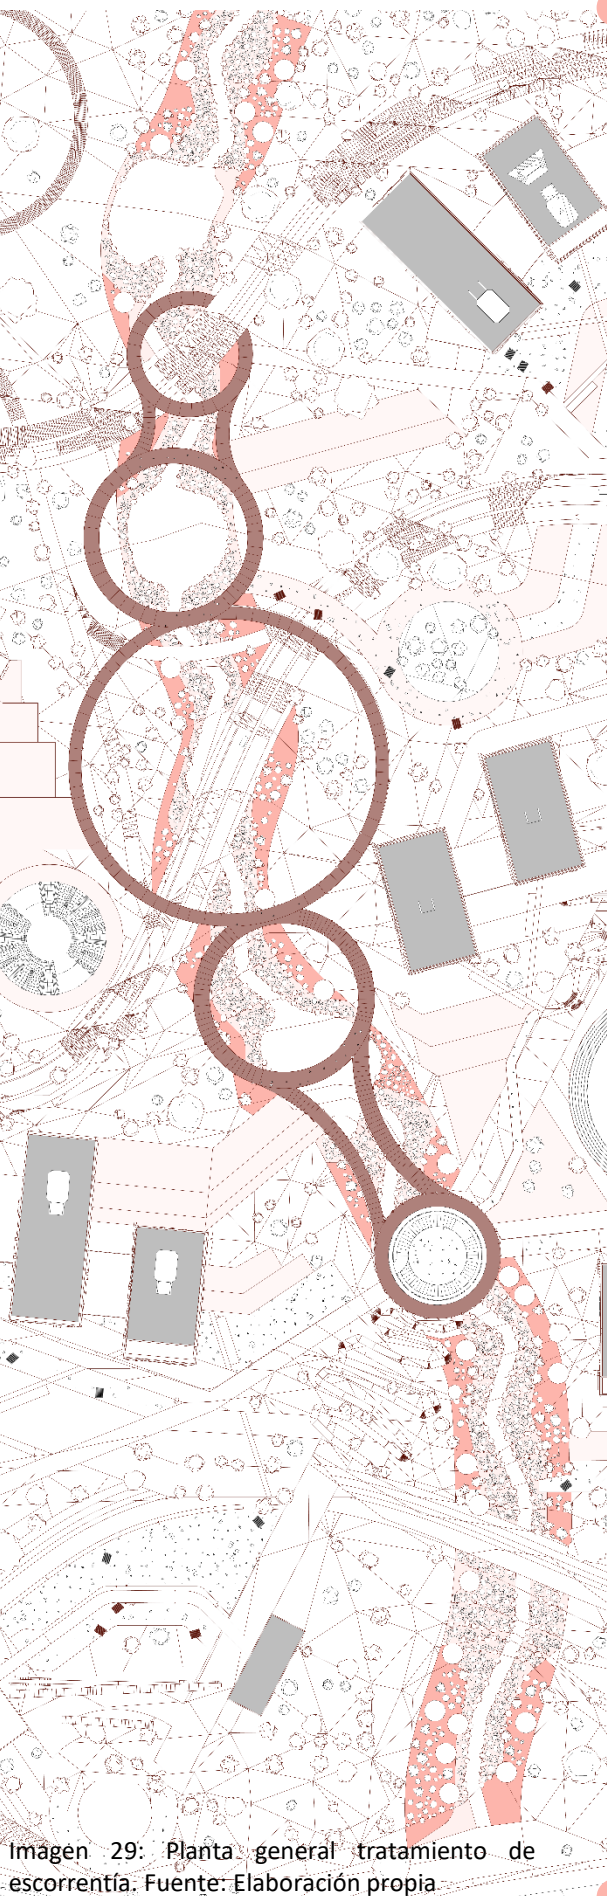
Planta general tratamiento de escorrentía. Fuente: Elaboración propia
